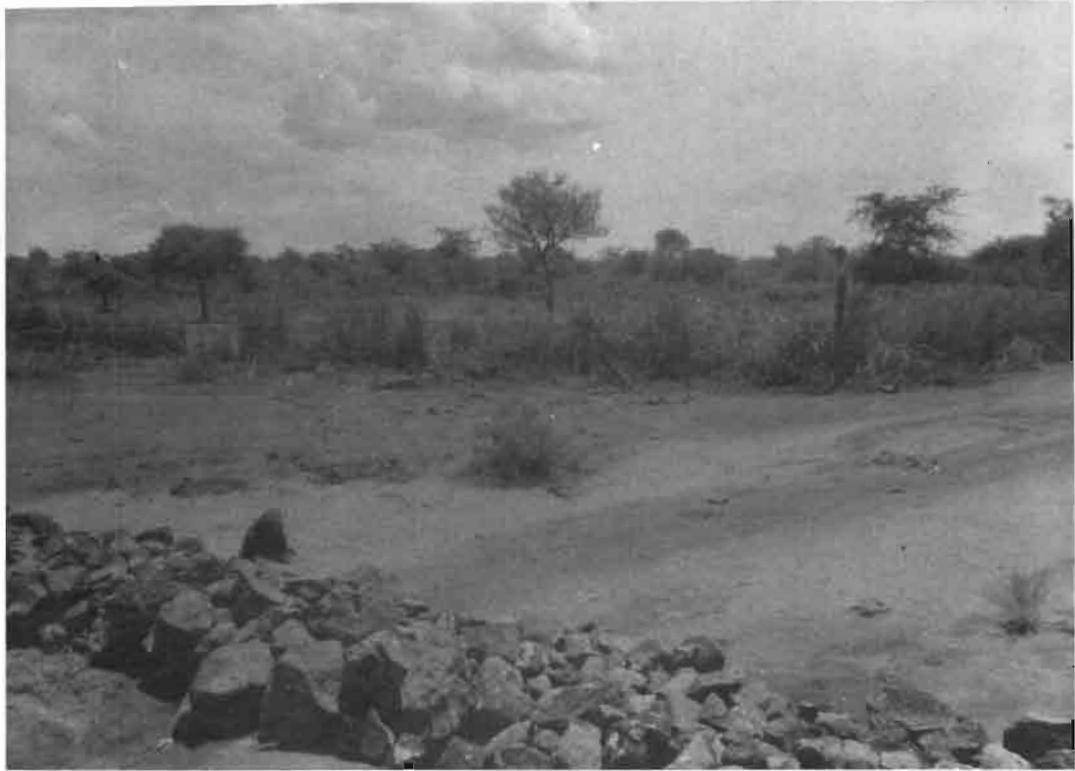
cordon de pierres stabilisant un chemin érodé par le passage du bétail, Nakuru, Kenya
